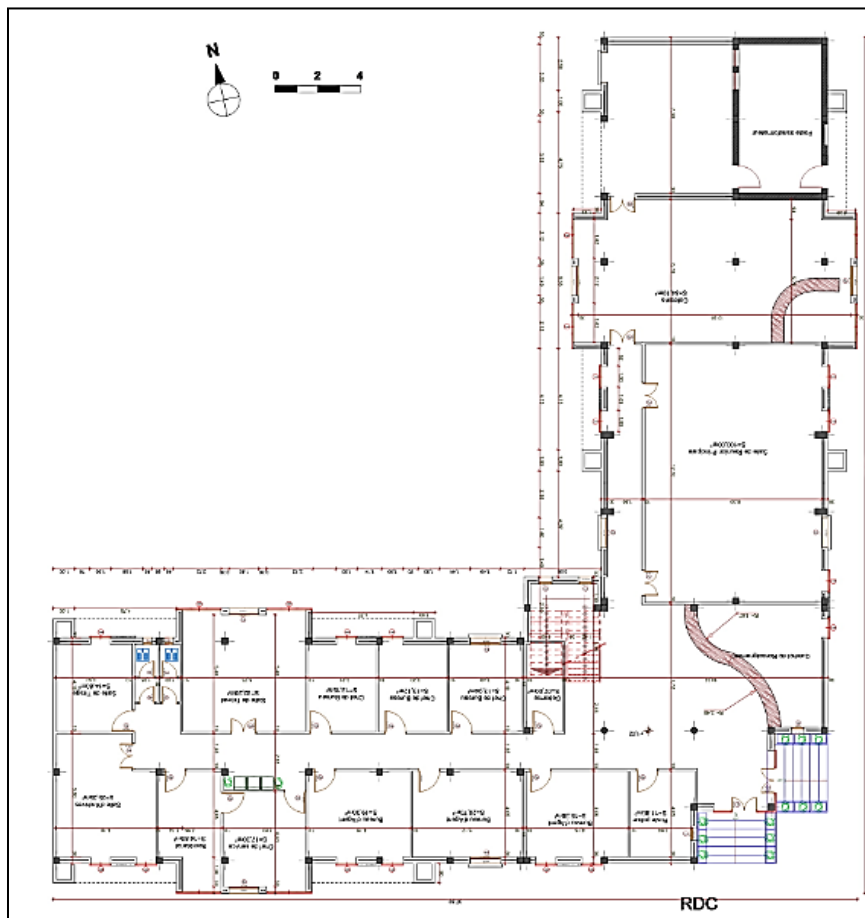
plan RDC, du siège DUAC, (source: BET Top-building Bendjima)
